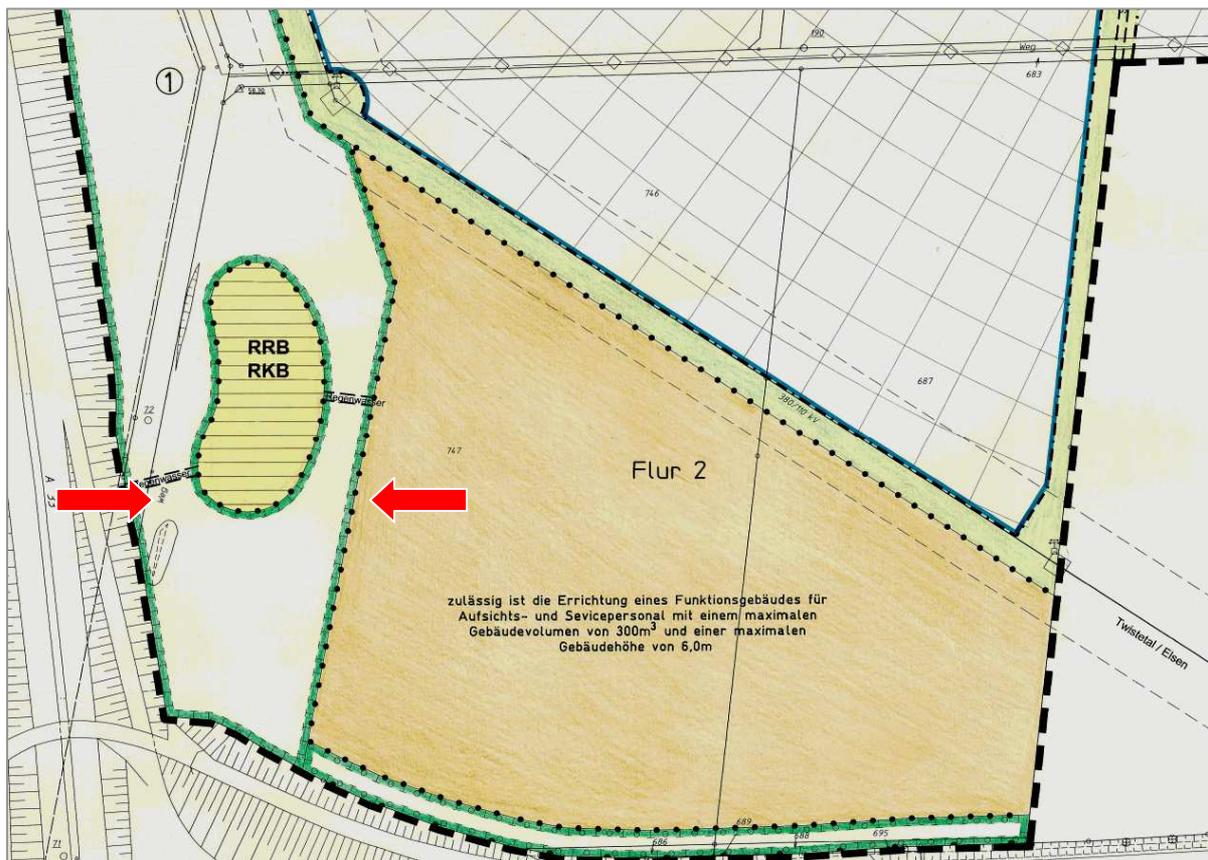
Ausschnitt W 223 - Bereich ADAC und Rückhaltebecken
